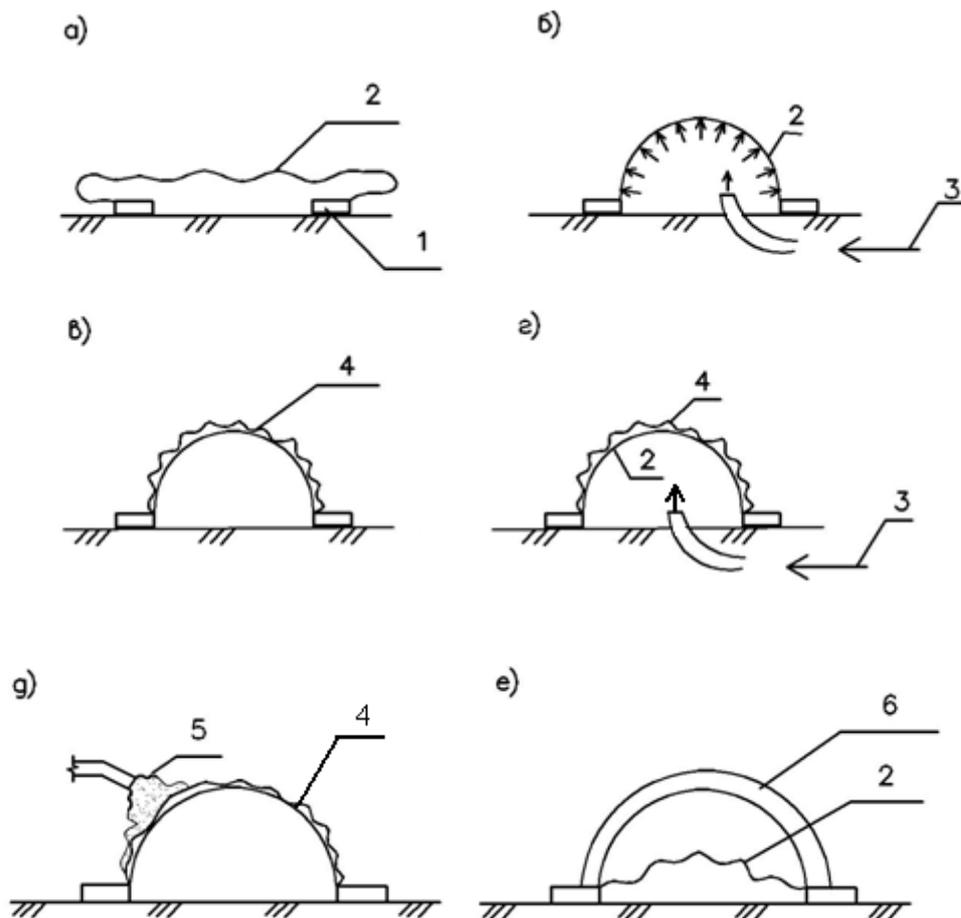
Схема бетонирования оболочки на пневмоопалубке:
